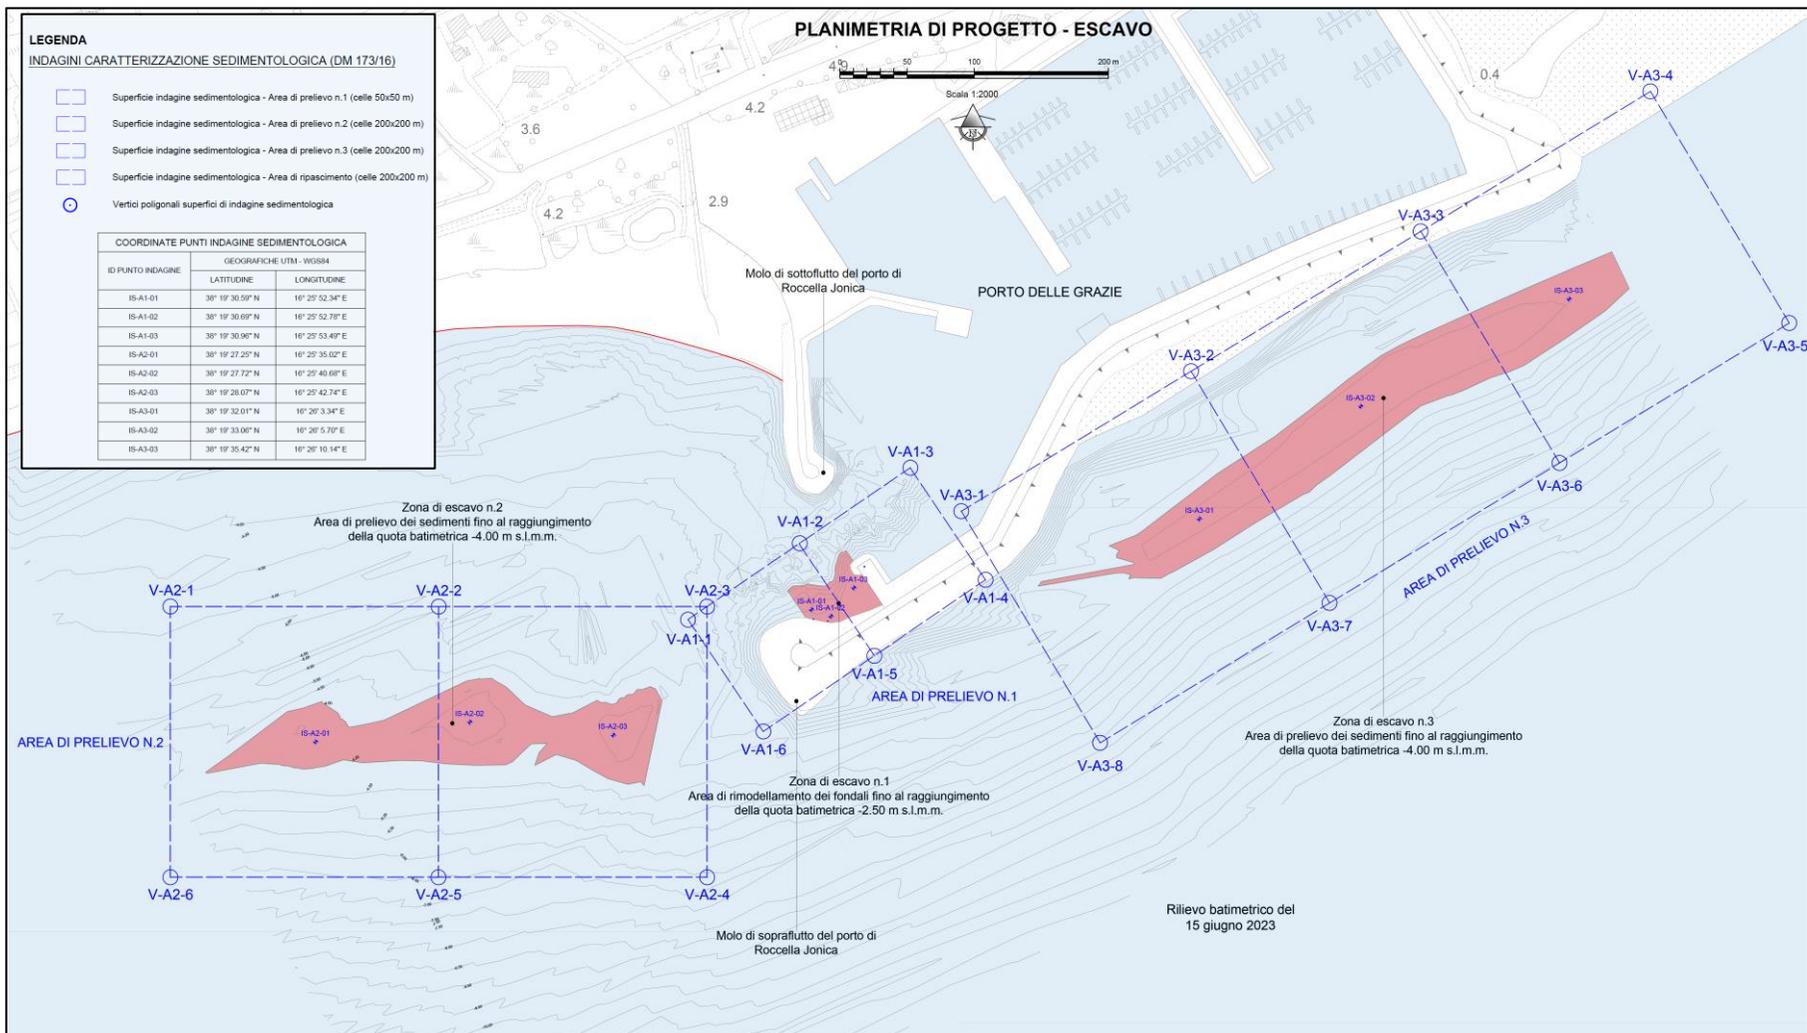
Planimetria di progetto con individuazione punti di campionamento dell'area di prelievo
